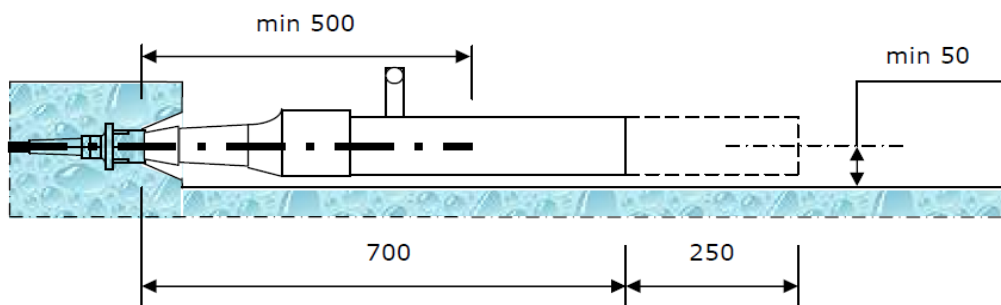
Kahe silindriline tungraud, külgsaade [33]
